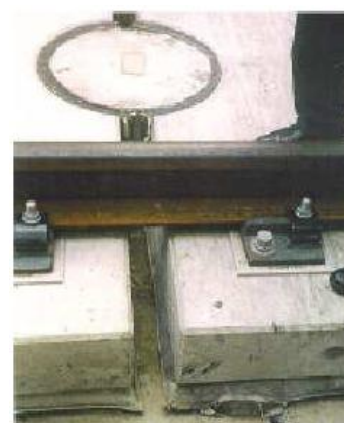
Laje Pré-fabricada com fixação direta - Shinkansen Slab Track[48]
